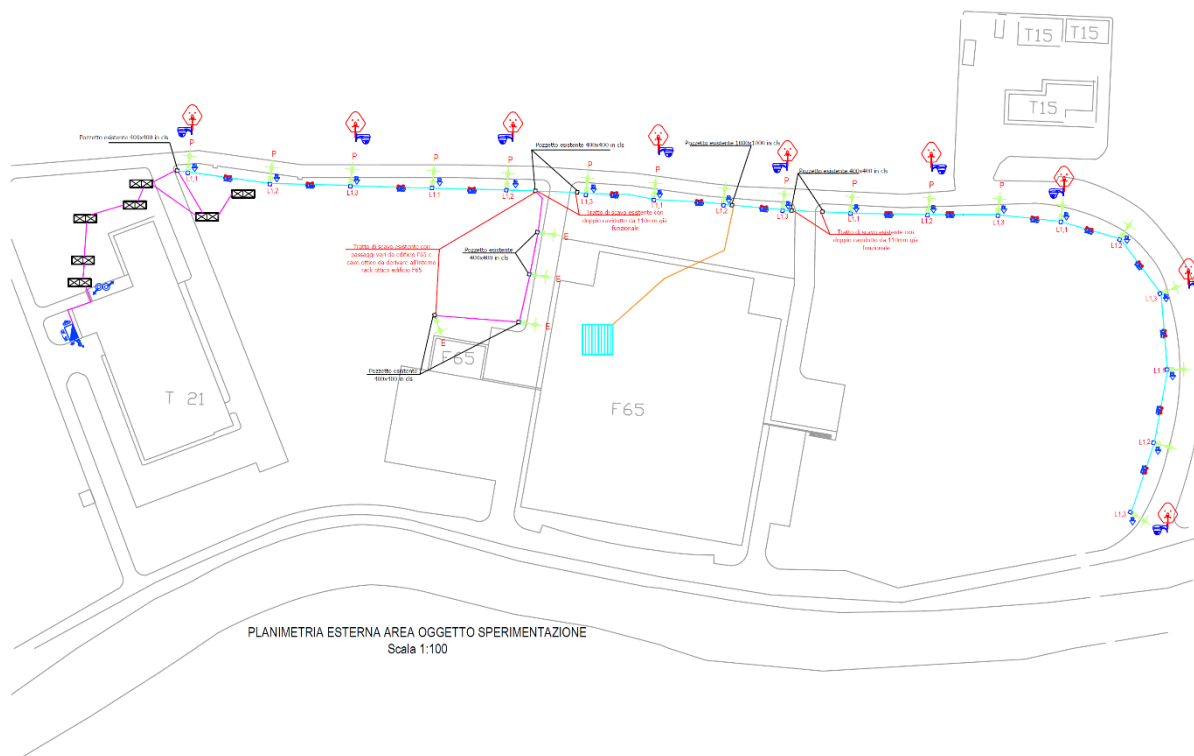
Planimetria esterna del progetto “Smart Road”.
